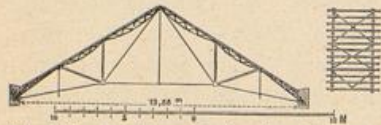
Dachkonstruktion eines Retortengebäudes der Imp.-Cont.-Gas-Ass. in der Gitschiner Strasse No. 19 (früher Hellweg 8).
